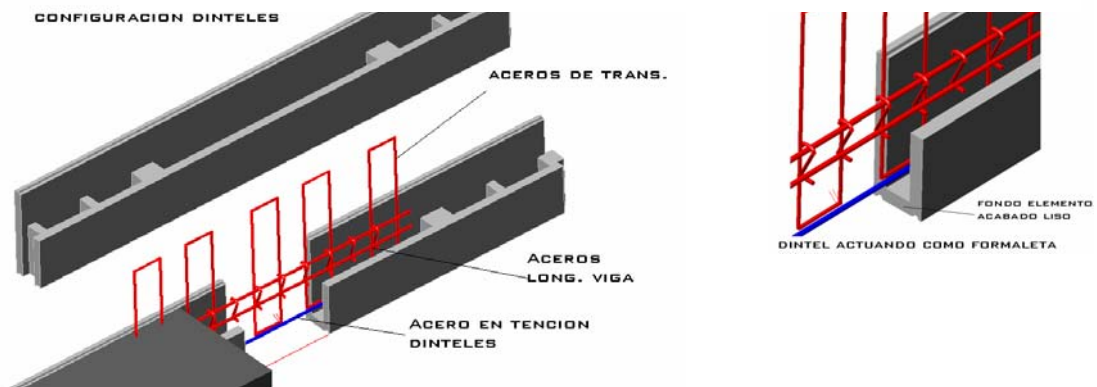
DETALLE ELEMENTO DE DINTEL UNIÓN MURO DIAFRAGMA
